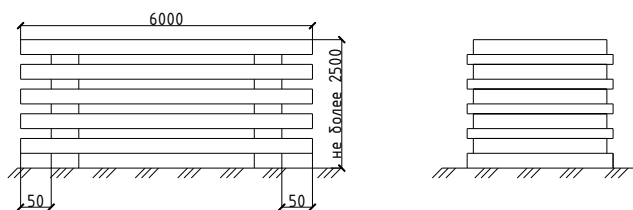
Схемы складирования конструкций (плит перекрытия)
